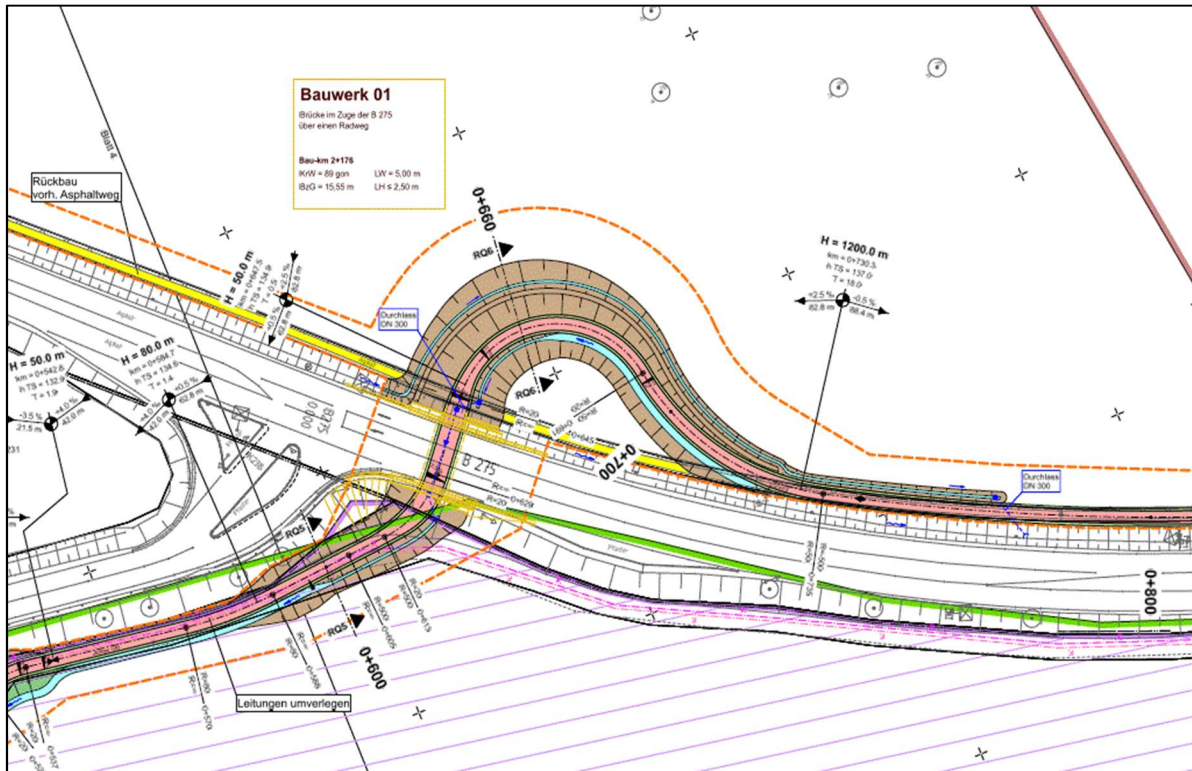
Lageplanausschnitt von Bauwerk – BW 1
